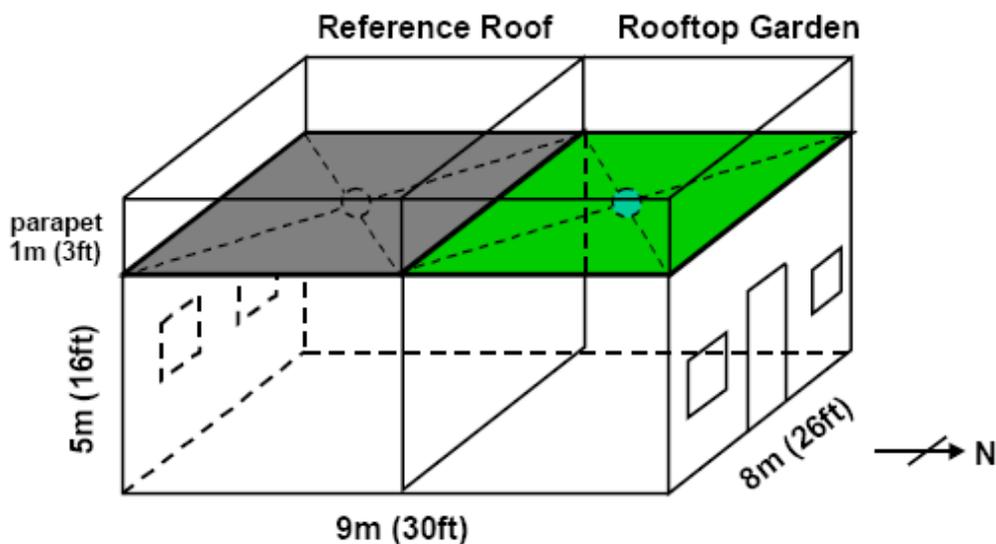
Esquema del Filed Roofing Facility (FRF), el edificio usado para la experimentación. (Fuente: Bass & Baskaran, 2003)
